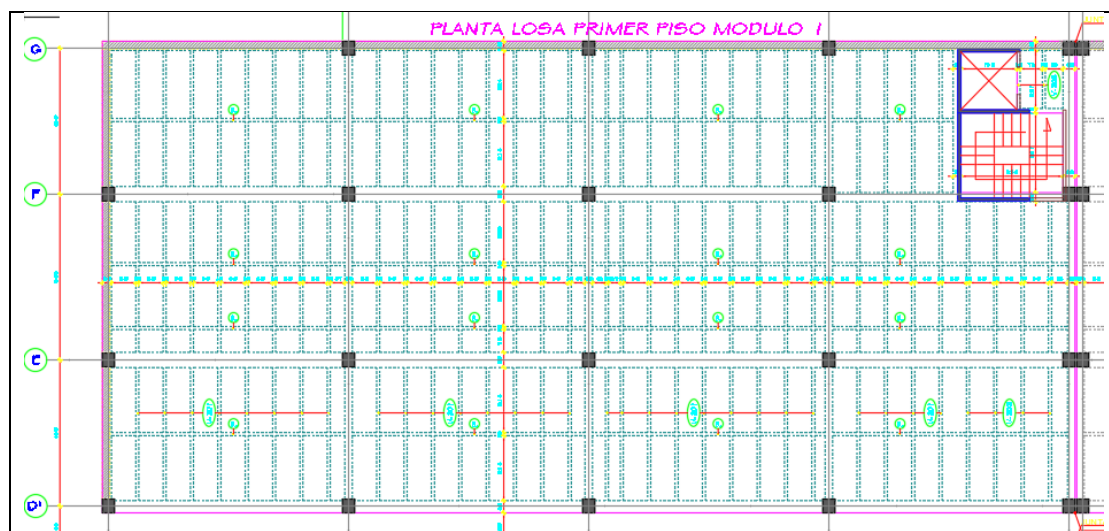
Planta de la losa del primer piso del módulo 1 de parqueaderos.
